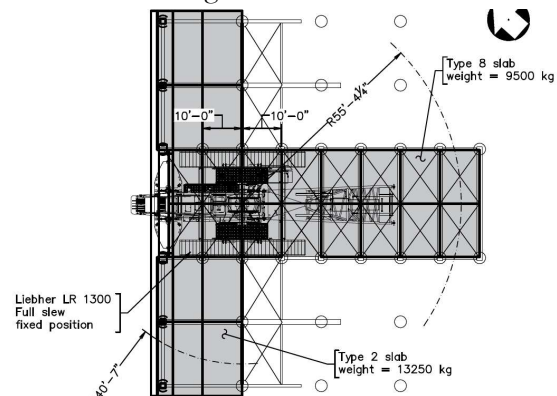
Esquema constructivo de la plataforma de descarga y acopio.
